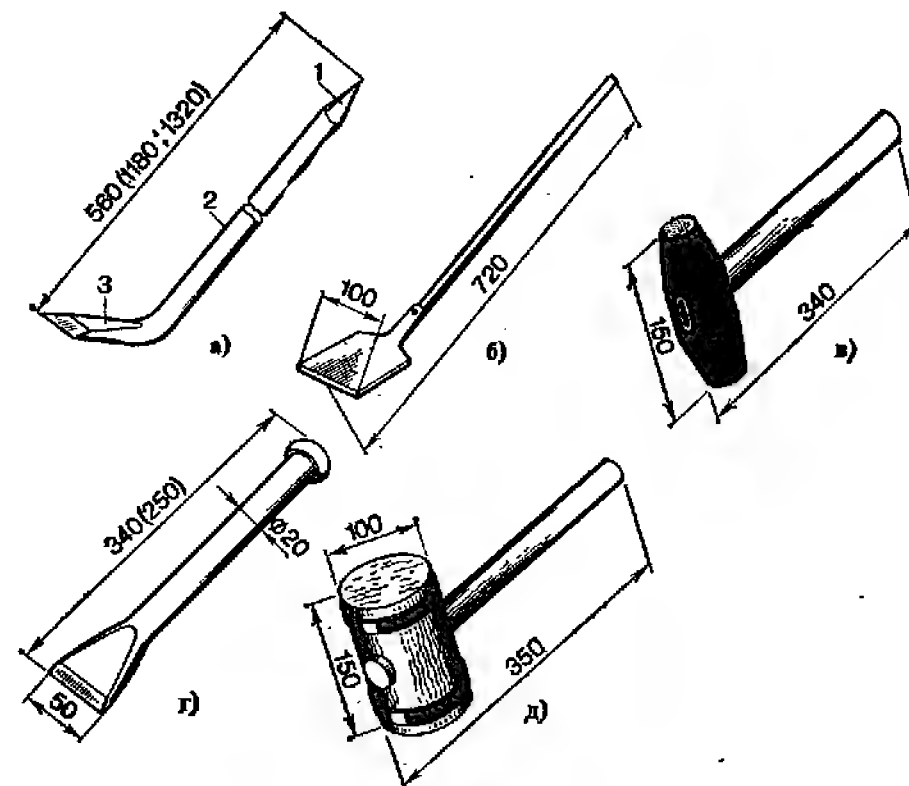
Ручной инструмент монтажника железобетонных конструкций: а — монтажный лом (ЛМ), б — подштопка, в — молоток, г — конопатка, д — киянка
